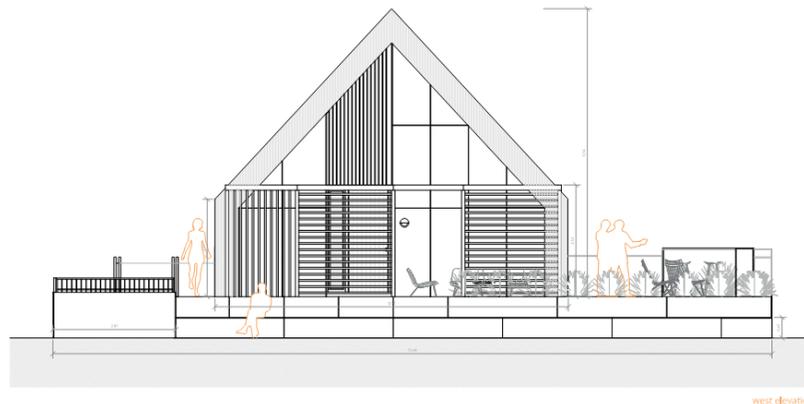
Alzado oeste del proyecto. Fuente: Azalea.
